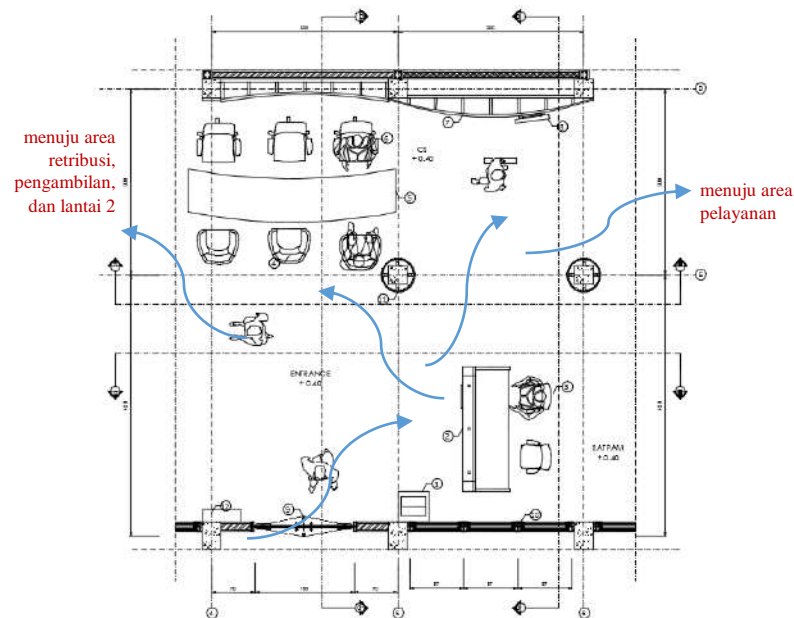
Denah Keseluruhan Lantai 1 dan Denah Ruang Terpilih 1
